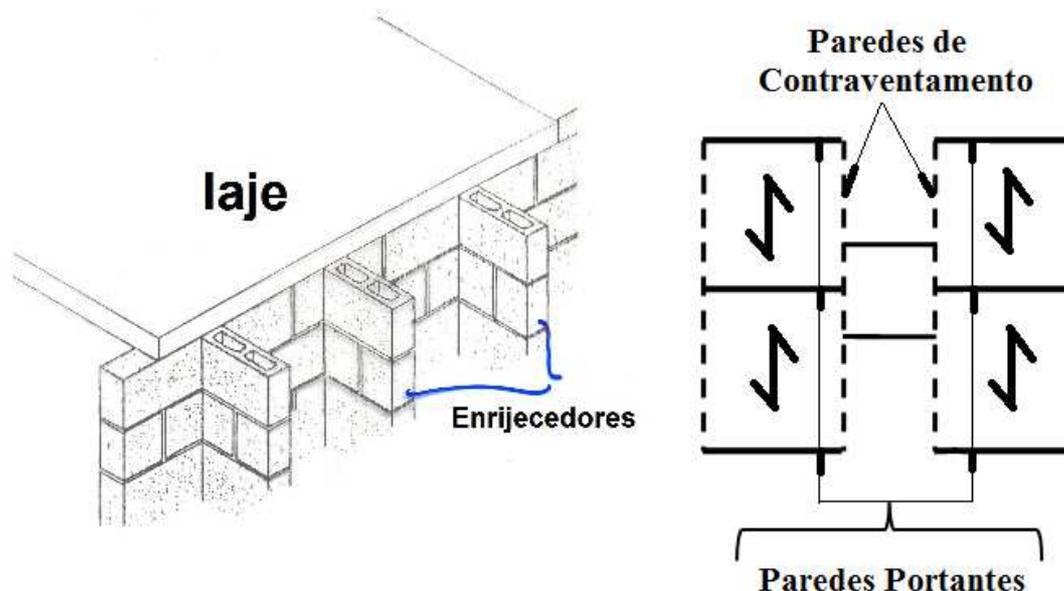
Paredes com enrijecedores e paredes de contraventamento;
